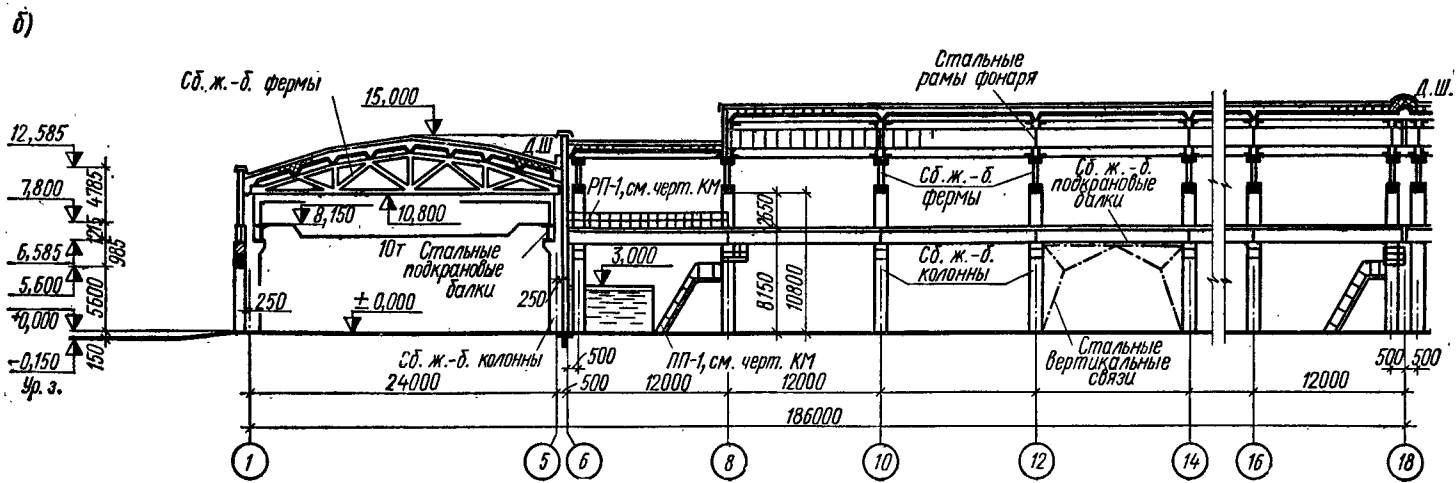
Примеры графического оформления разрезов одноэтажного промышленного здания с железобетонными несущими конструкциями:
